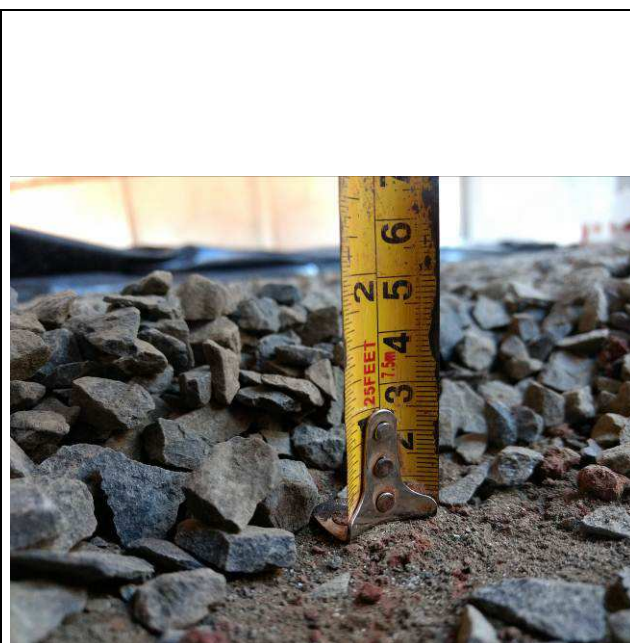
C: Aplicação da lona e da tela metálica - contrapiso Arquivo.
